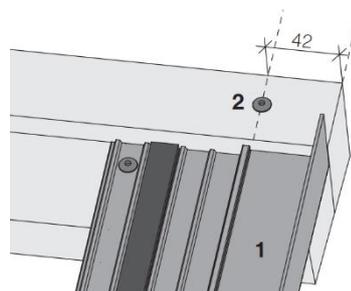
Schraubenabstand (Quelle: Swisspearl Details Sunskin Roof Lap)
